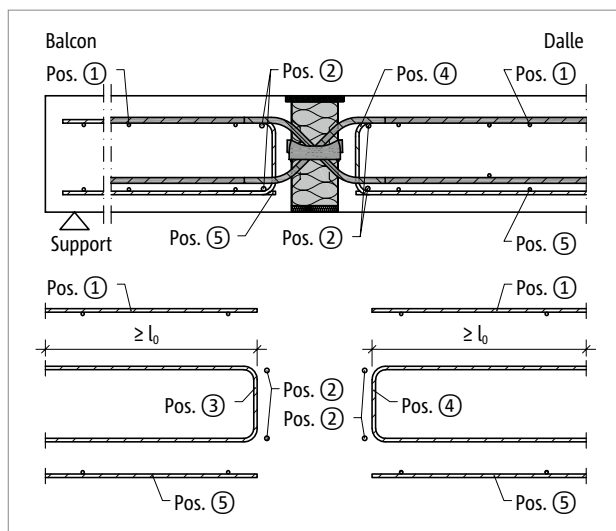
Schöck Isokorb® T Type Q-E-VV : Renforcement sur site
